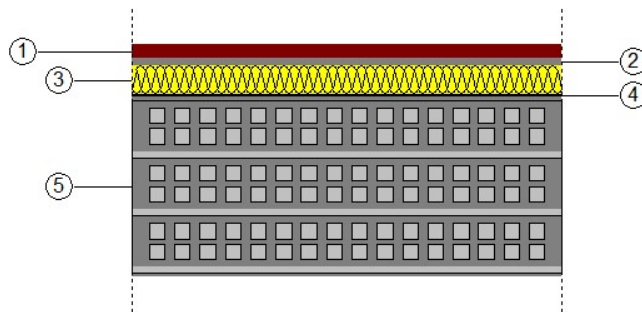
Ubicación fachada revoco mortero. Fuente: Elaboración propia
